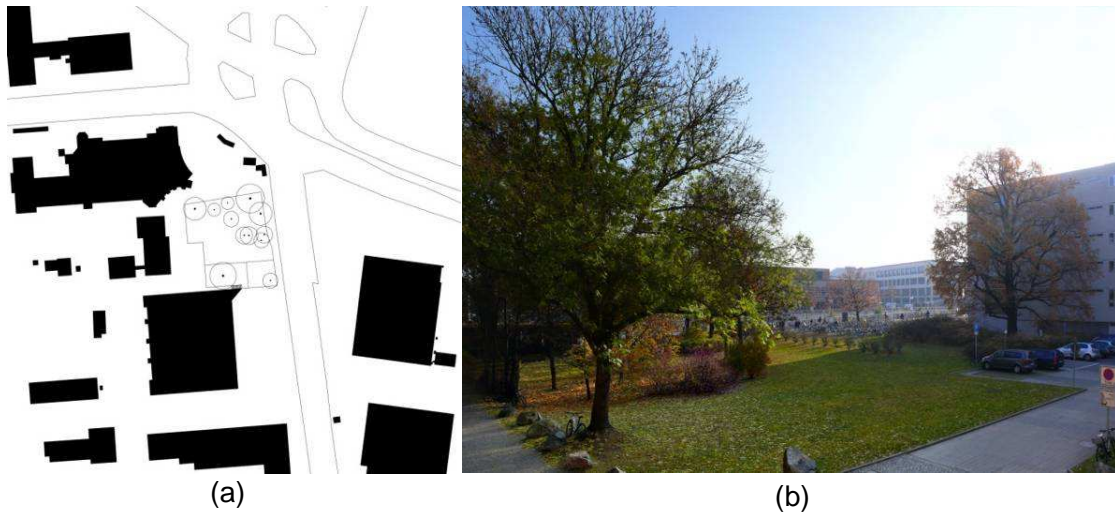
a) Lageplan [1] b) Blick auf Grundstück
